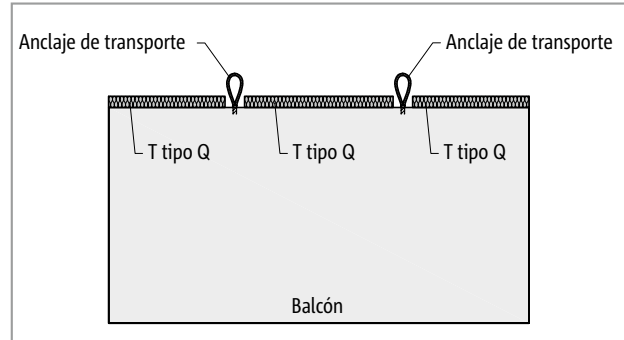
Schöck Isokorb® T tipo Q: Balcón de elementos con anclaje de transporte; en obra se puede colocar el adaptador aislante T tipo Z
